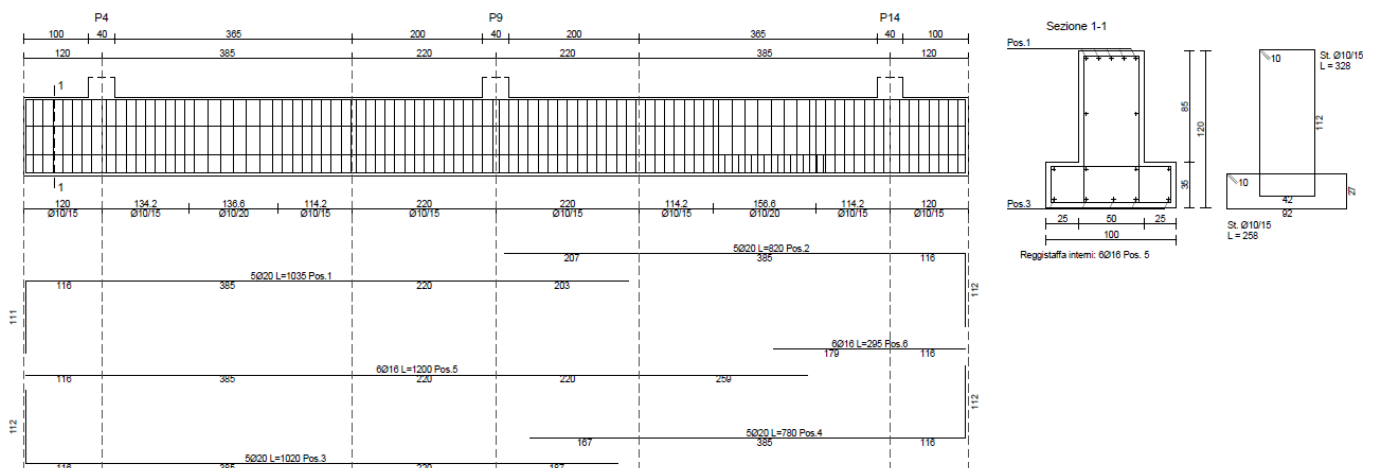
Tipologico ferri di armatura travi rovesce di fondazione
